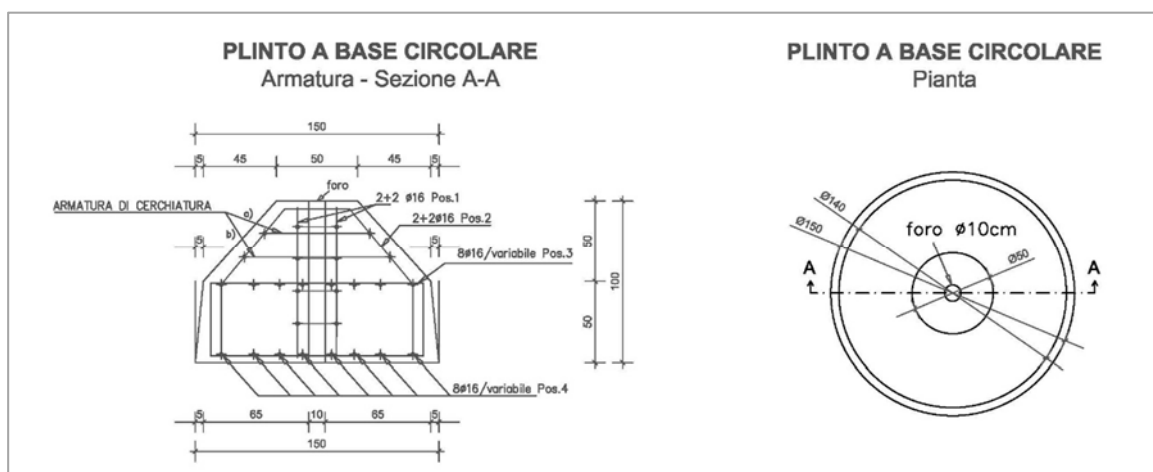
Schema tipo di una piastra flottante tronco-conica a base circolare: sezione, pianta e dettagli esecutivi.
